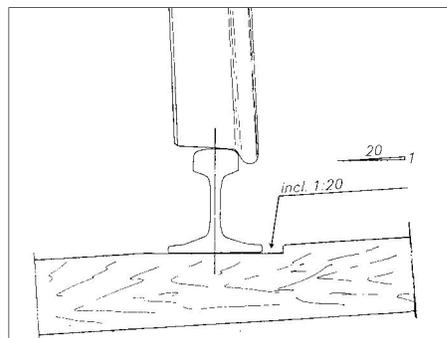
Inclinação transversal do carril [Adaptado de 41]
